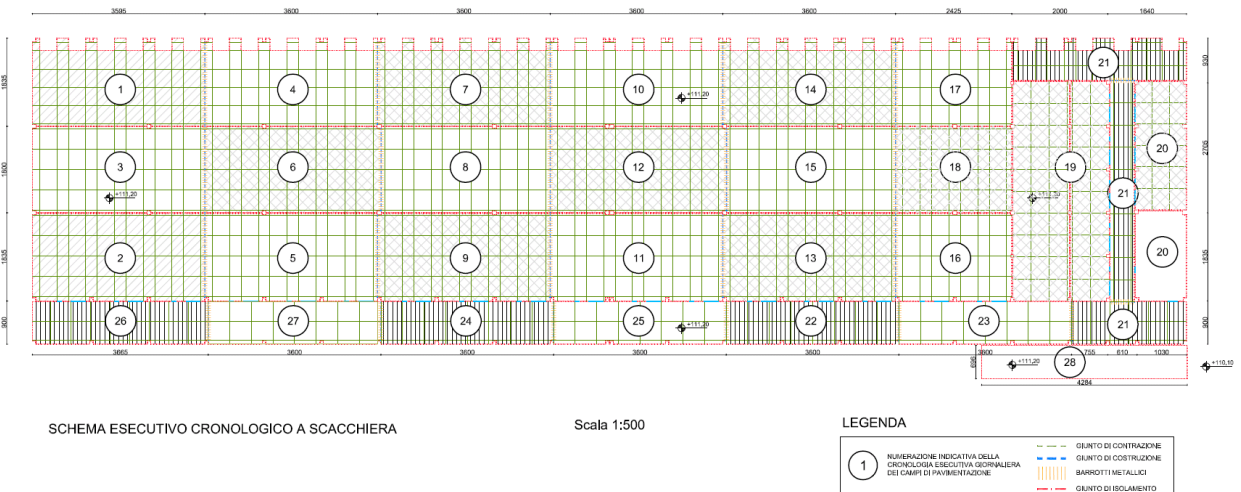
Fasi cronologiche giornaliere di realizzazione della pavimentazione
